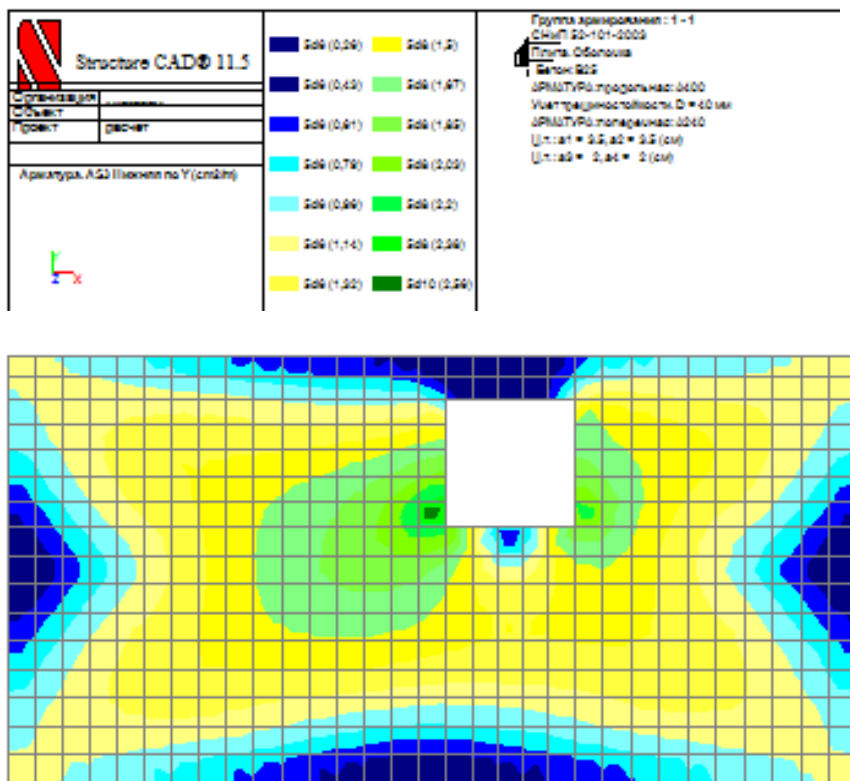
Схема нижнего армирования плиты по оси y
